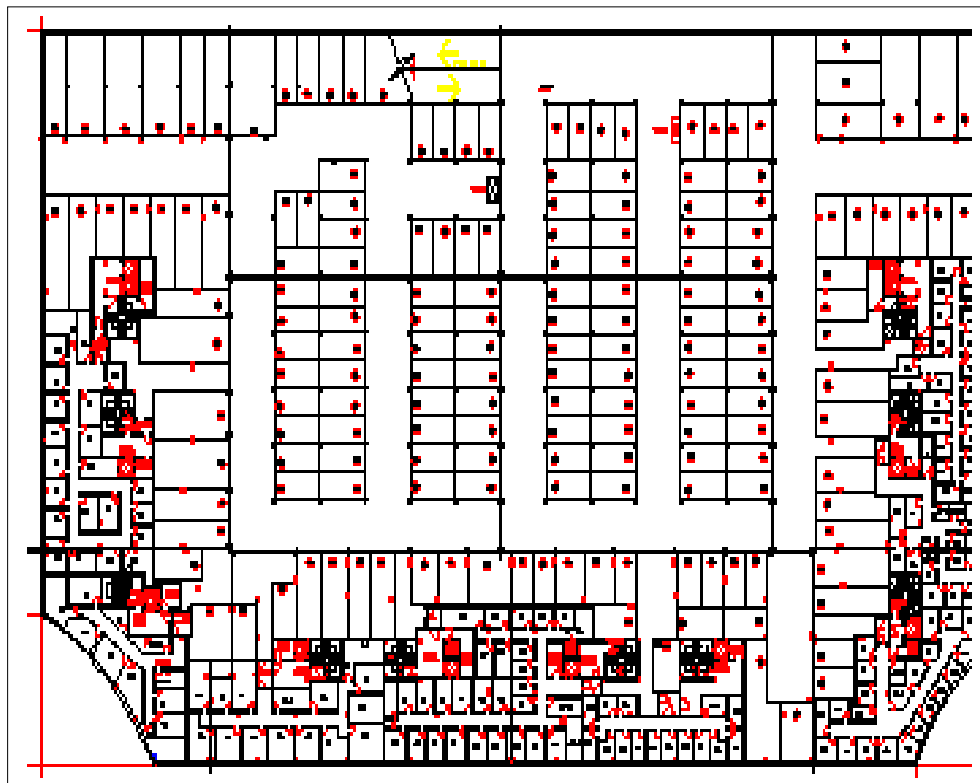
Vista en planta de la planta sótano 2. Fuente: Departamento de Ingeniería Térmica y de Fluidos, Universidad Carlos III de Madrid.
